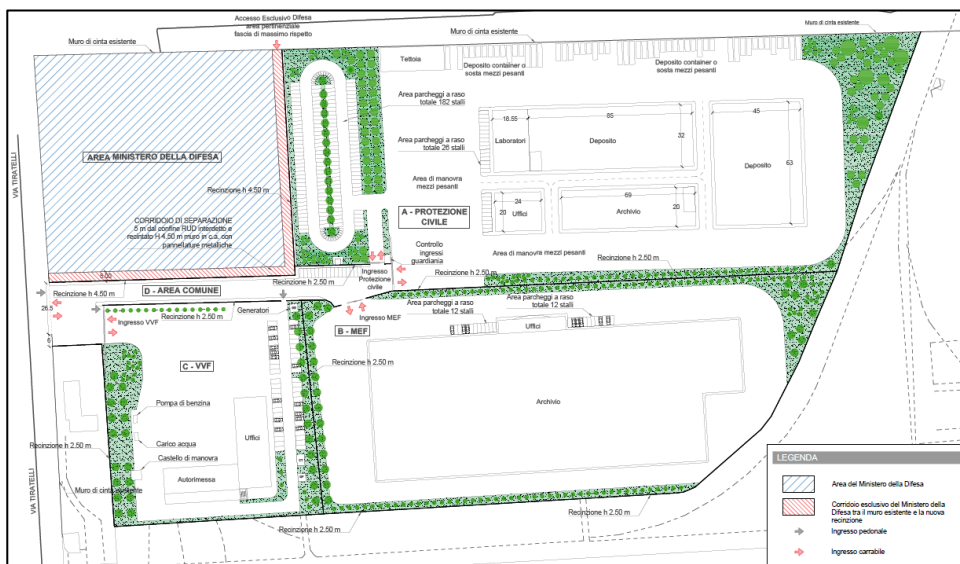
Planimetria con suddivisione dei lotti e ipotesi di sistemazione
